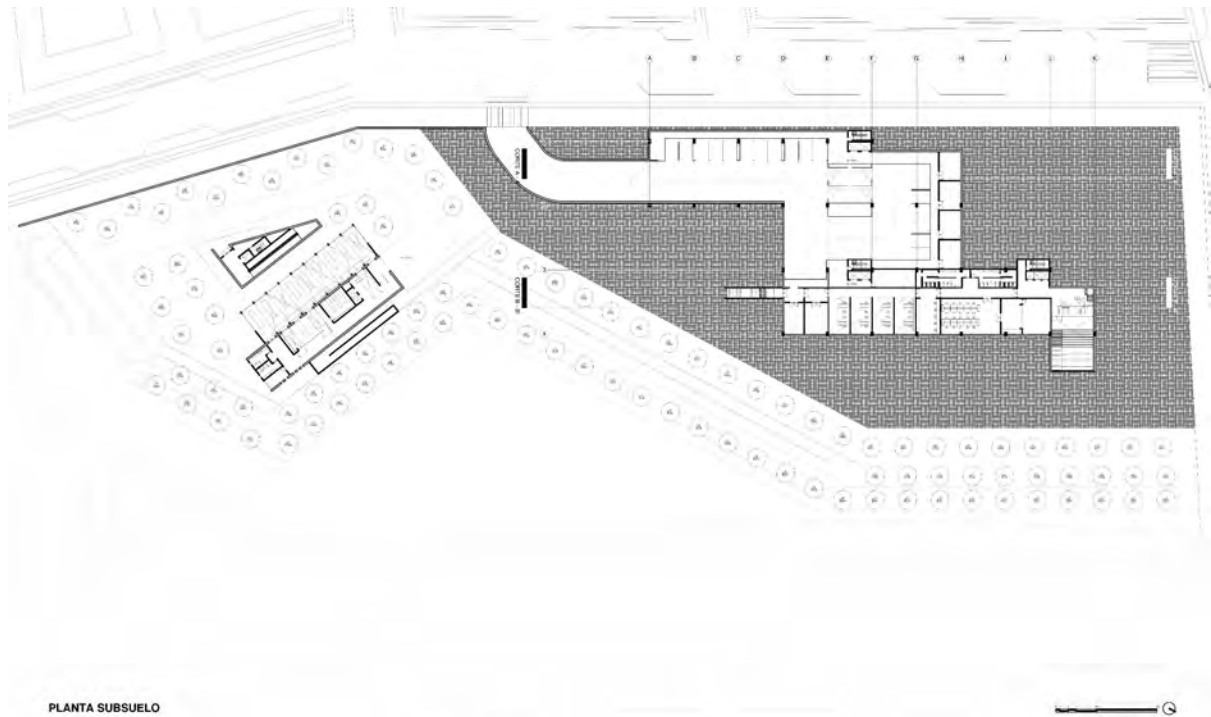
Planta subsuelo, Ilustración realizada por el autor
